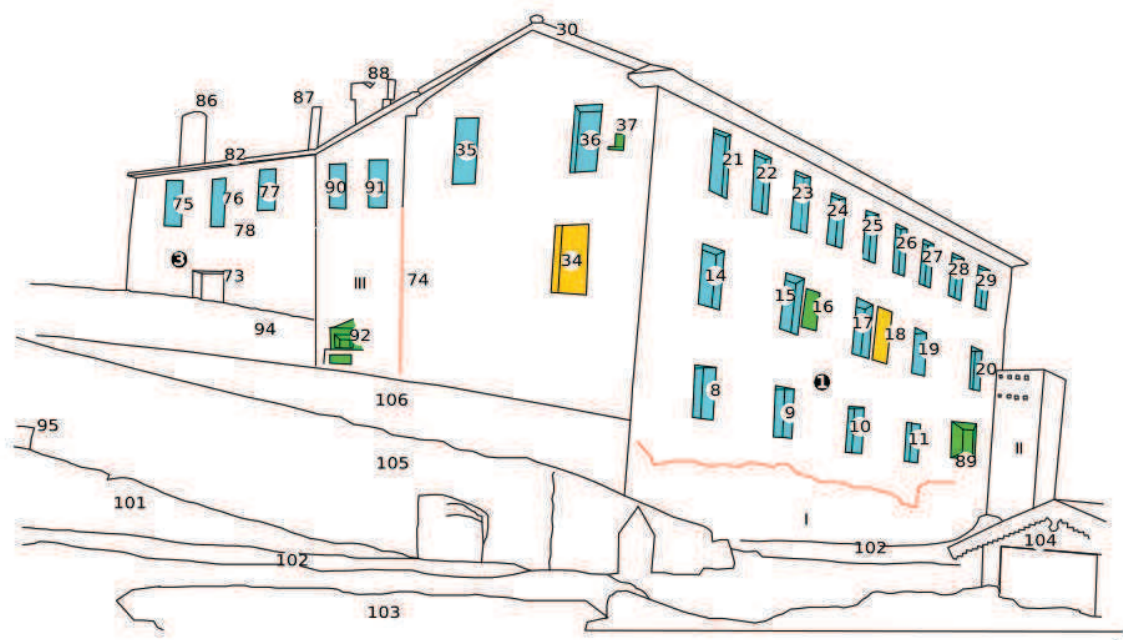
Croquis de la leyenda de elementos de la fachada.
